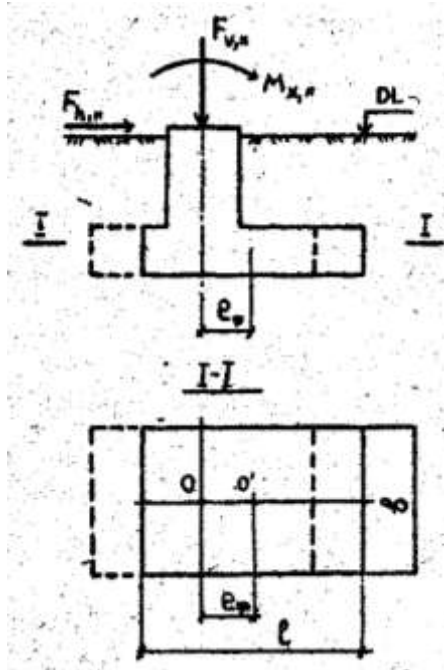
Схемы размещения подошвы фундамента относительно оси колонны при центральном нагружении (пунктирная линия); при действии значительных по величине моментов (сплошная линия): O – точка пересечения оси колонны с подошвой фундамента; O' – геометрический центр подошвы фундамента
